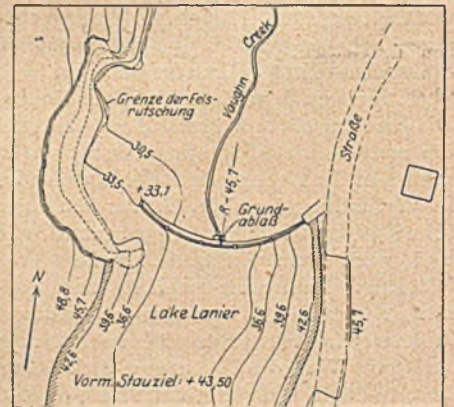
Lake-Lanier-Sperre nach dem Einsturz. Grundriß.
